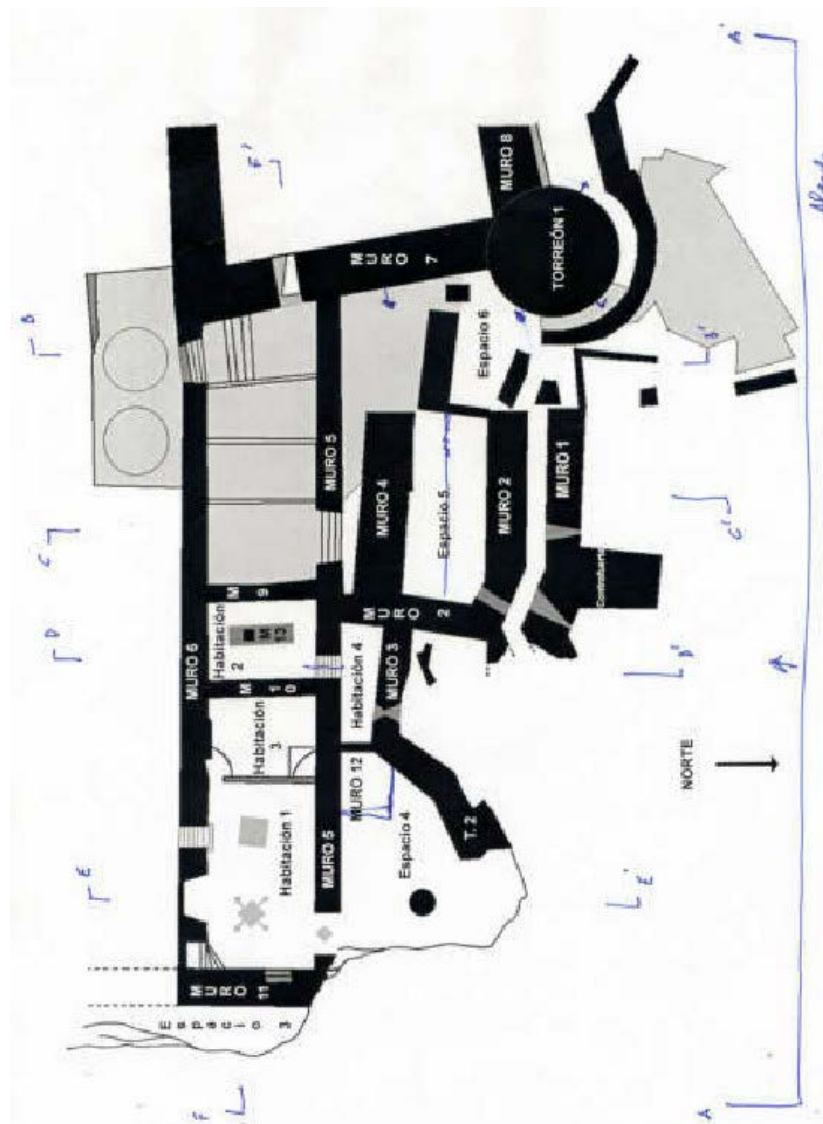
Croquis con las secciones y alzados necesarios para el proyecto de consolidación.
